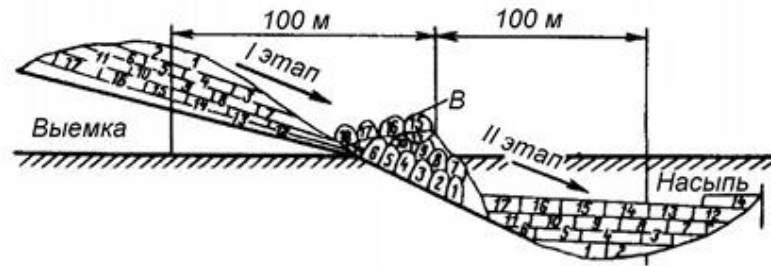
Схема способа перемещения грунта в два этапа
